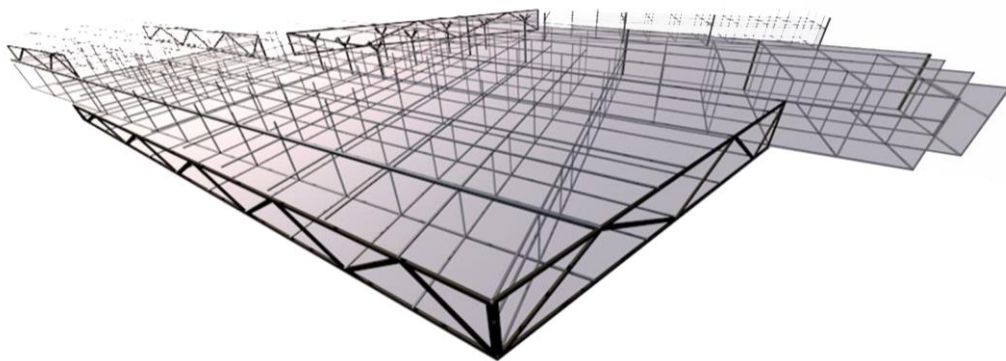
Alzado de la estructura.- Fuente. Autor del proyecto
